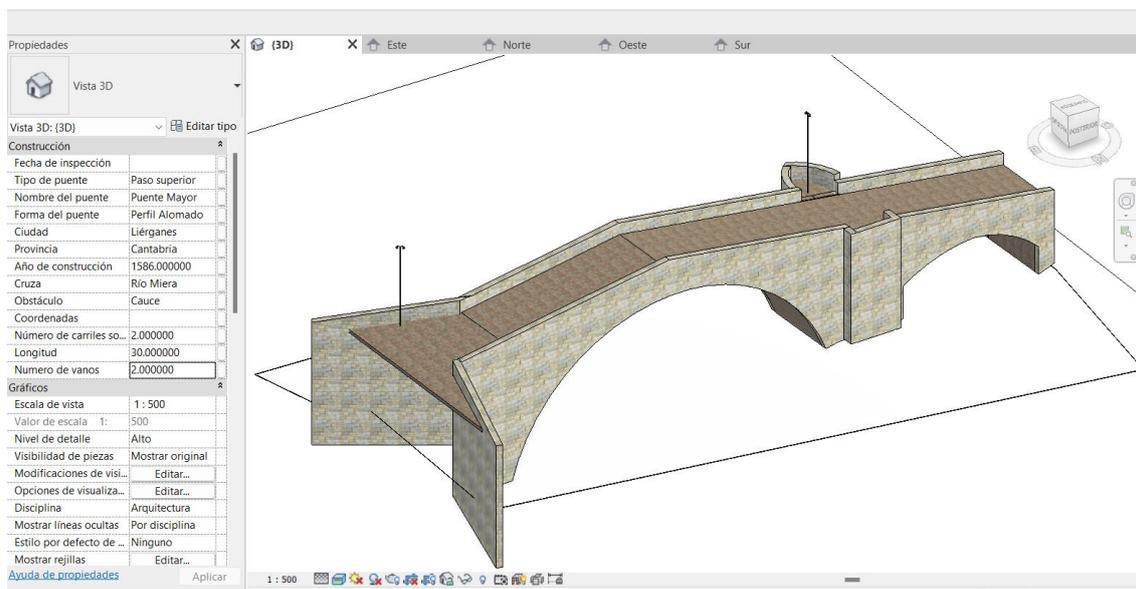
El modelo 3D del Puente Mayor en Revit
